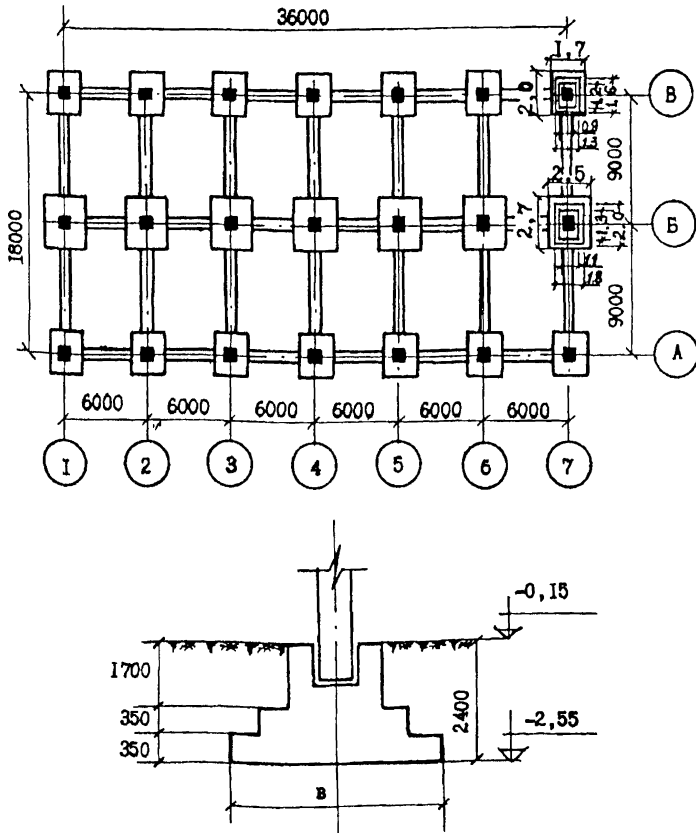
План и сечение отдельно стоящих фундаментов каркасного здания
